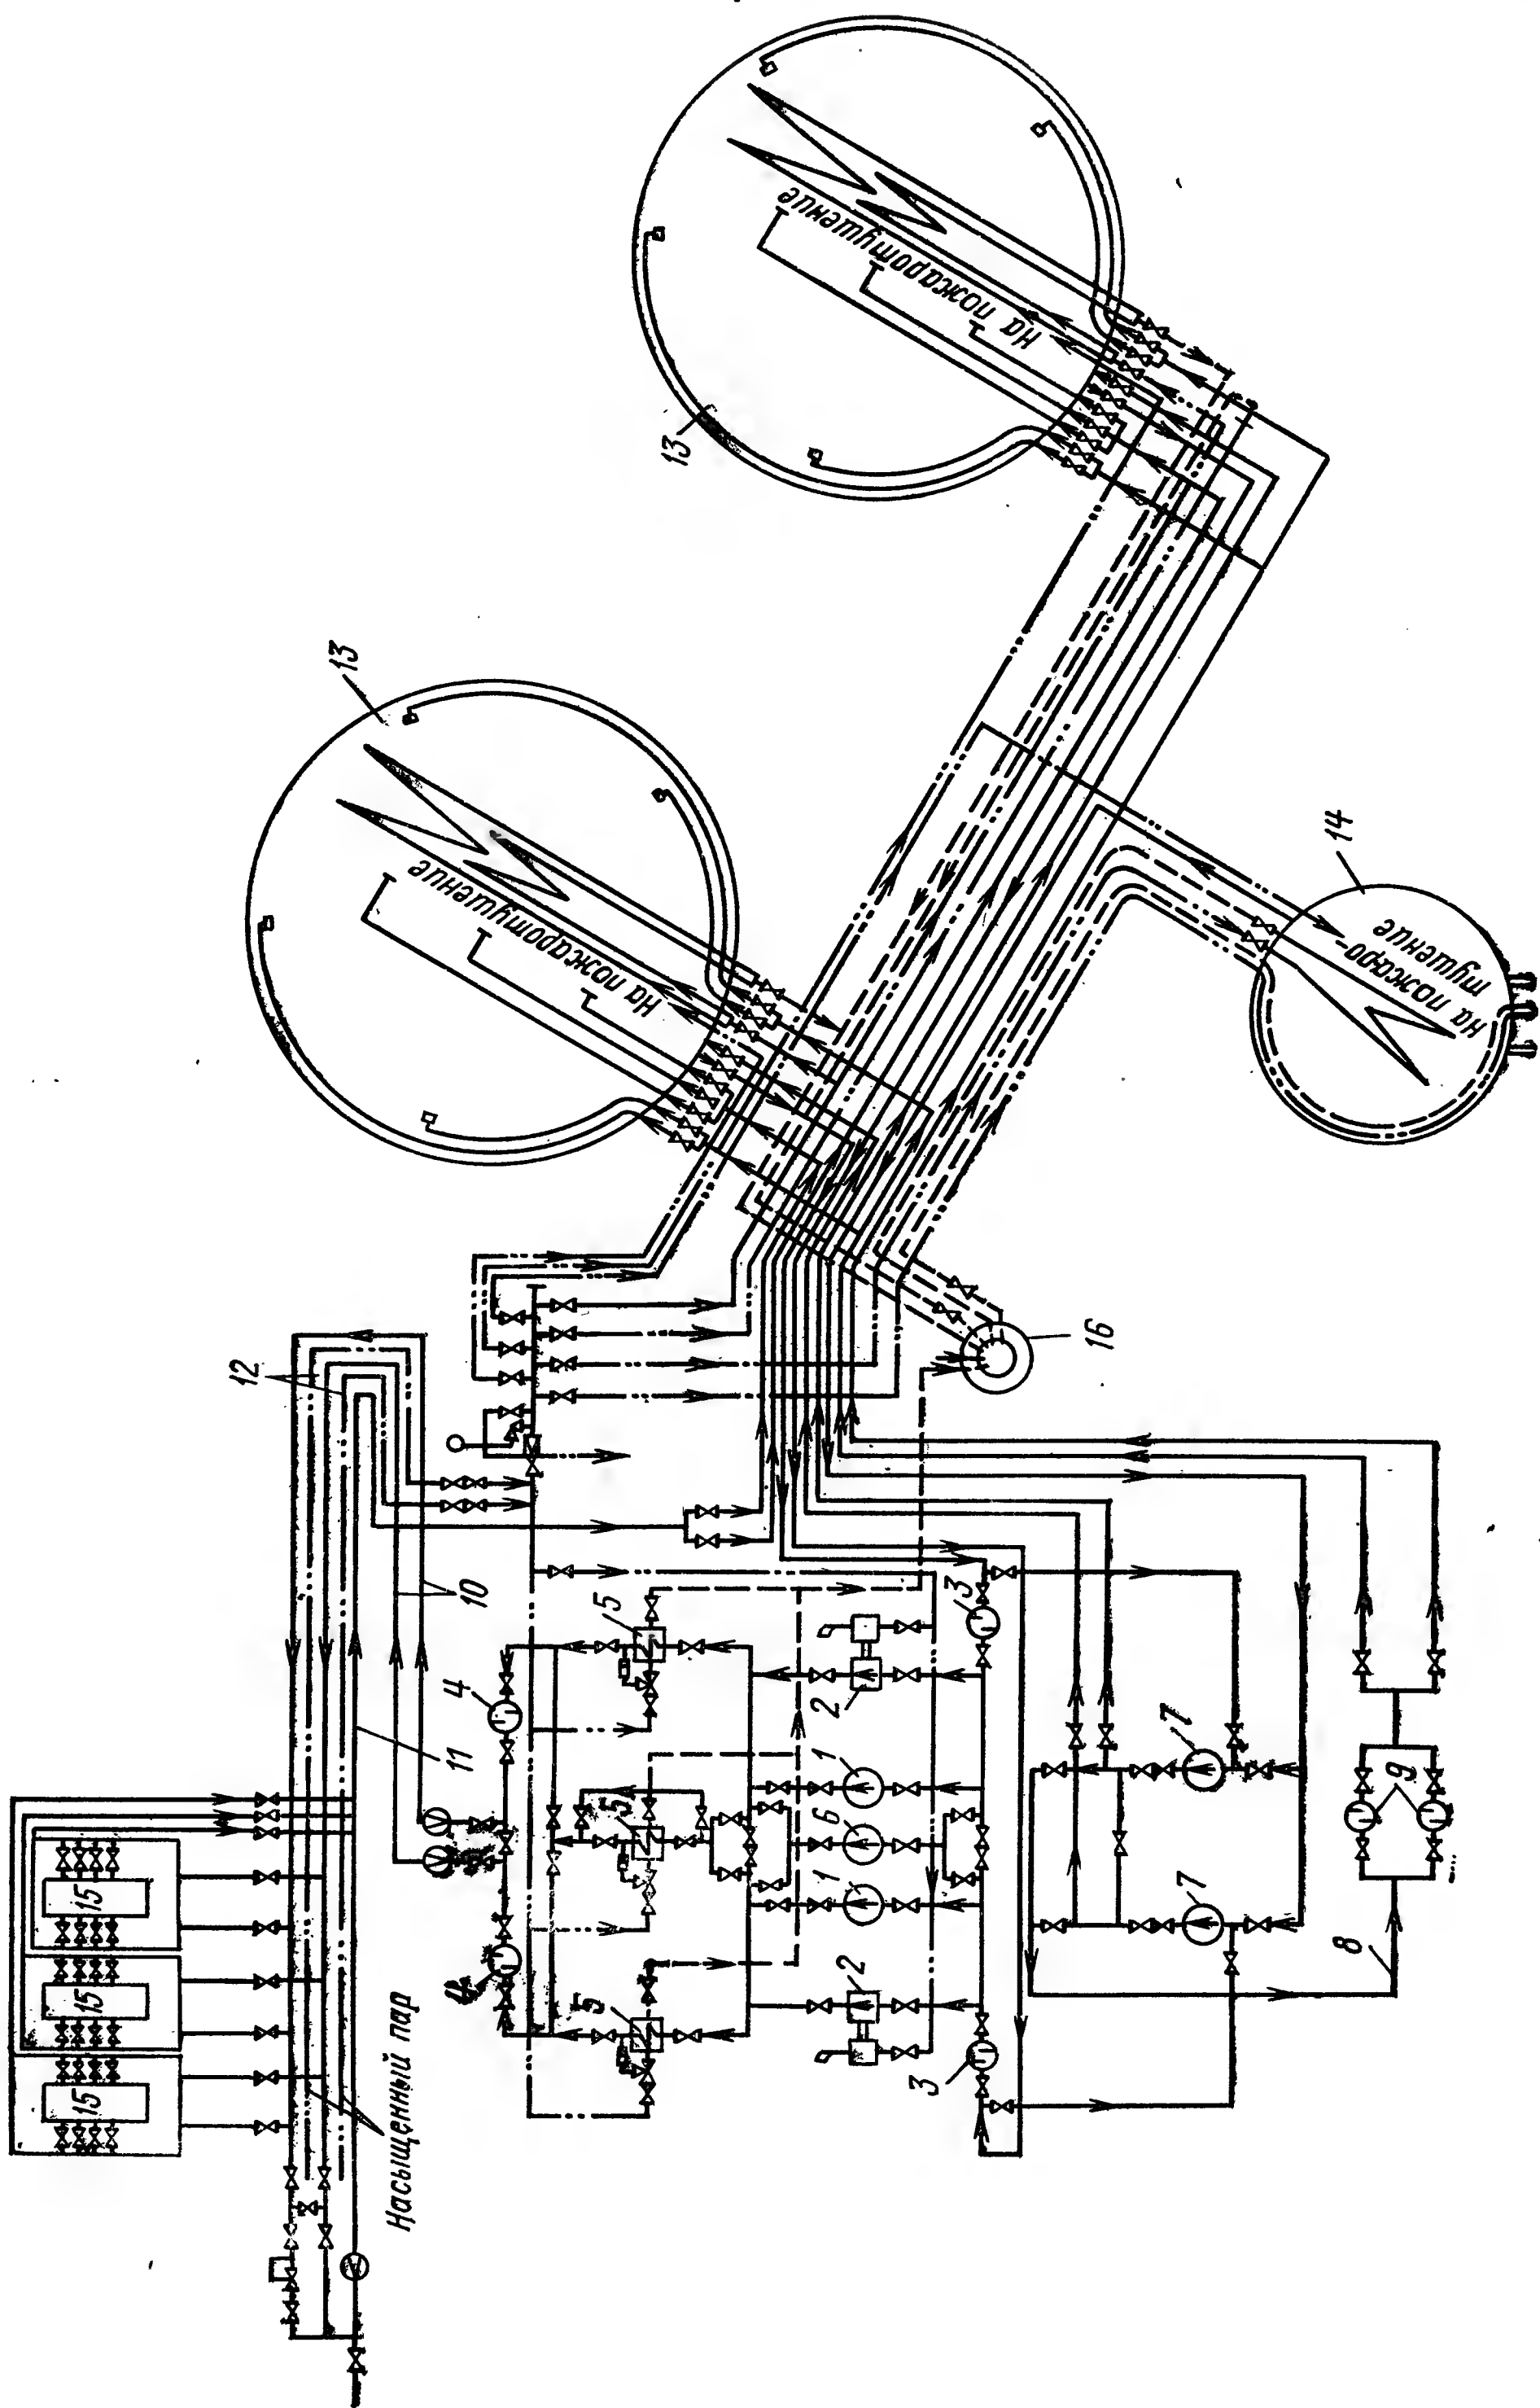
Схема трубопроводов и размещение оборудования в мазутном хозяйстве, хранилищах и котельной.
